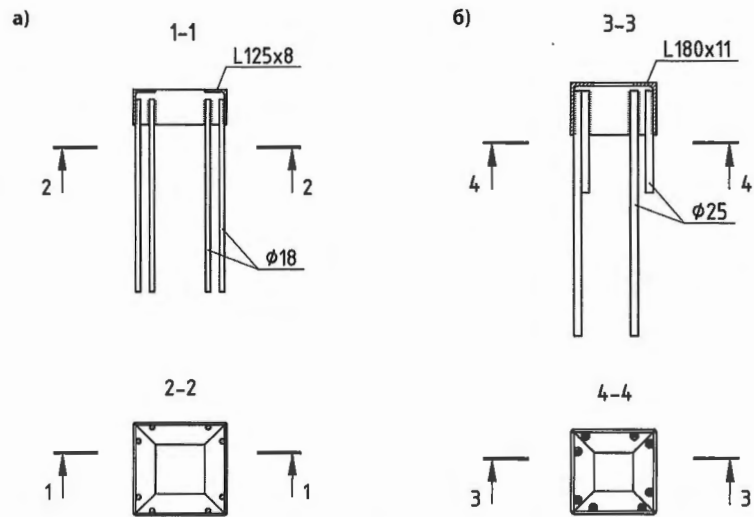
Закладные детали узла стыковки железобетонных свай при максимальном армировании:
